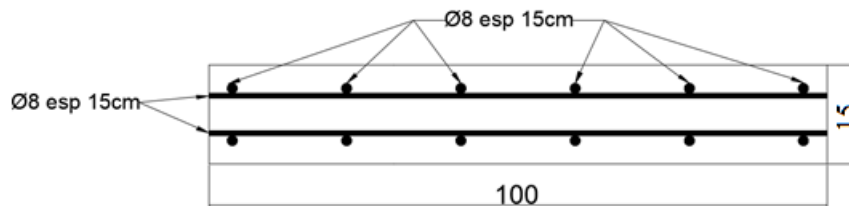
Ferrailage de la dalle rectangulaire (cm).
